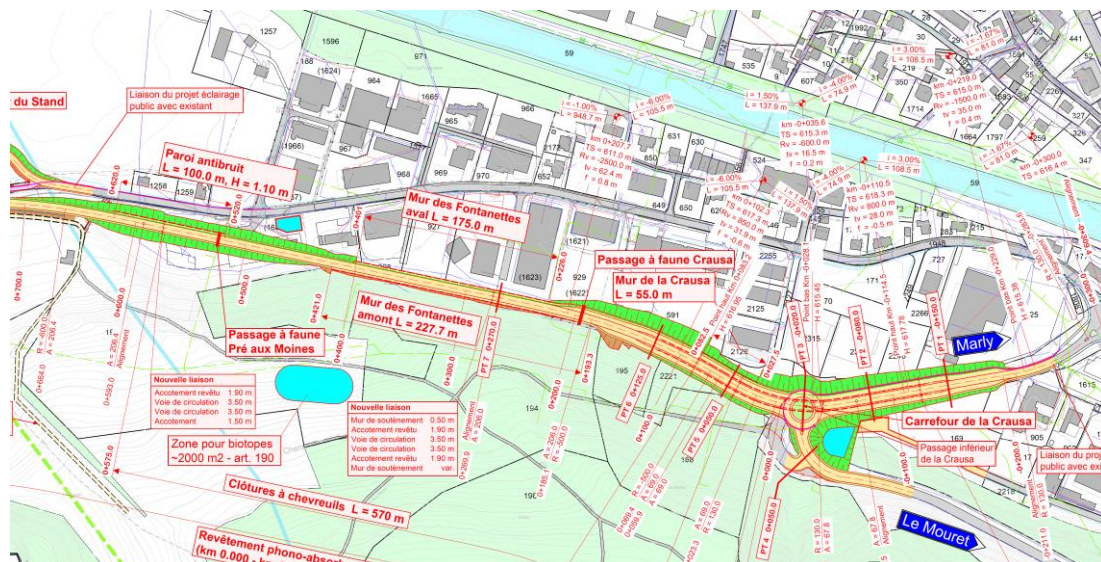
Situation carrefour de la Crausa- extrait plan EMMA+ (28.06.2019)
